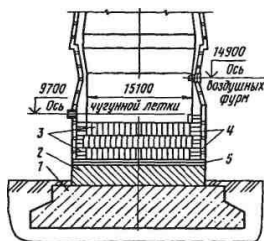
Фундамент и лещадь печи объемом 5500 м<sup>3</sup>: 1 — подошва фундамента; 2 — пень; 3 — углеродистые блоки; 4 — холодильники; 5 — воздушное охлаждение низа лещади
